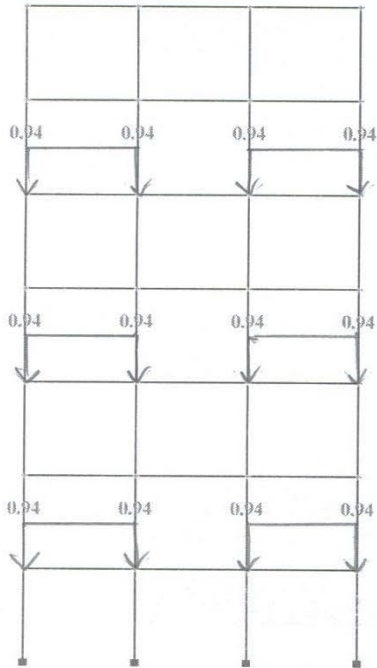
Схема завантаження рами у крайніх прольотах по чотних поверхам навантаження від людей та устаткування.
